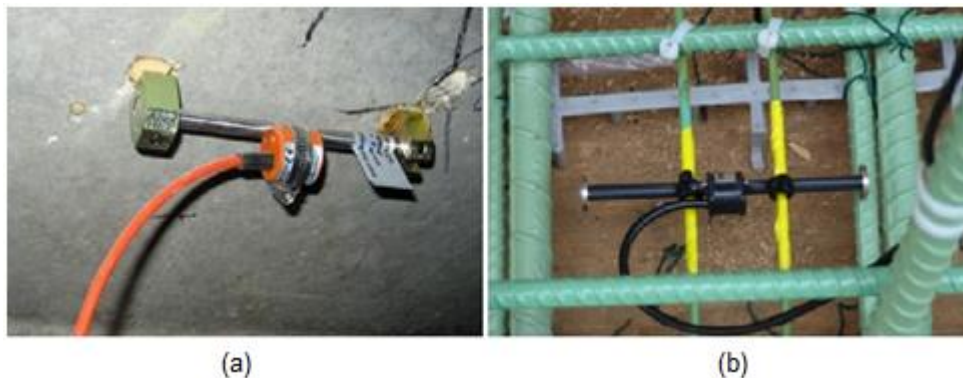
Exemplos de aplicação de extensómetros de corda vibrante (Rodrigues, 2012): (a) Aplicação na superfície do elemento estrutural; (b) Aplicação no interior do elemento estrutural.
